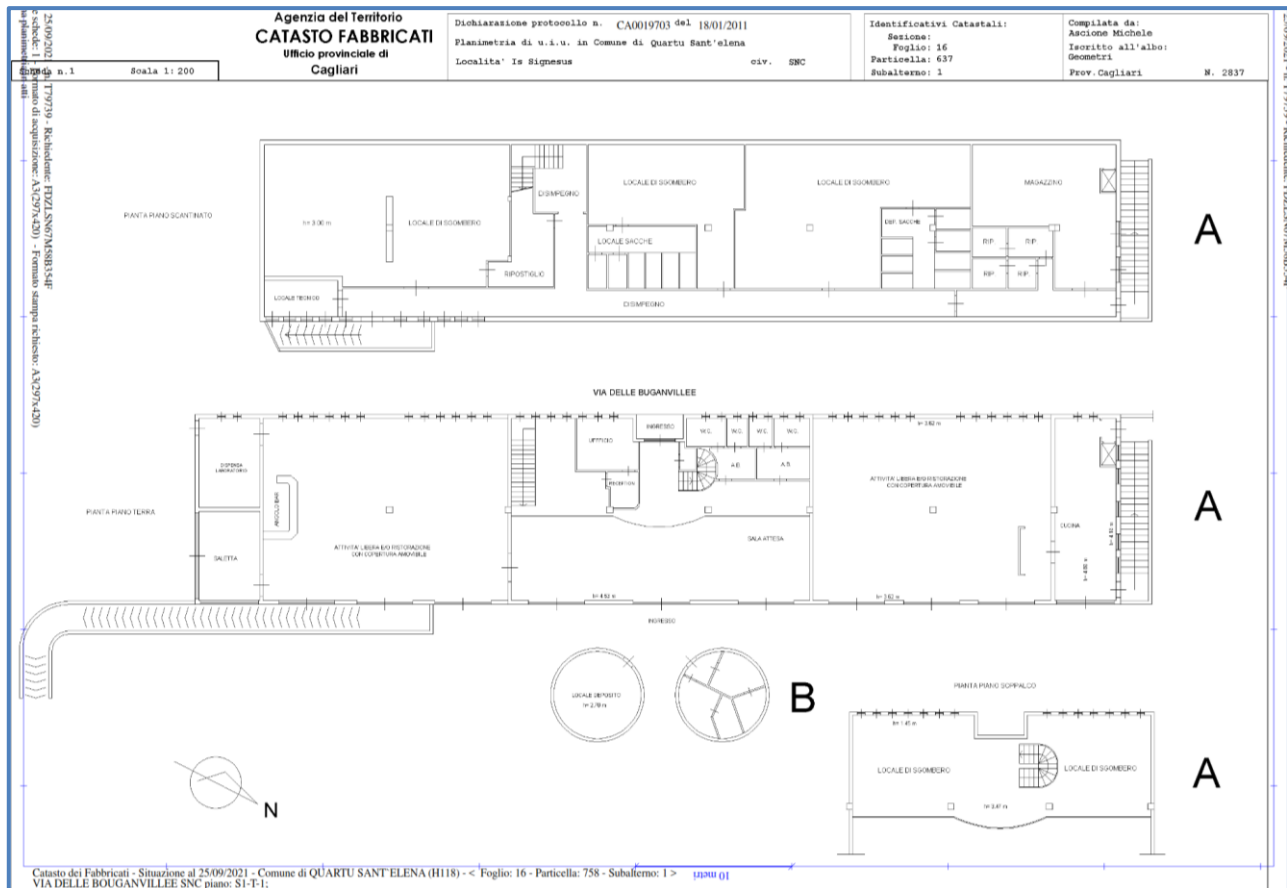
estratto della planimetria catastale della particella 758 sub.1
